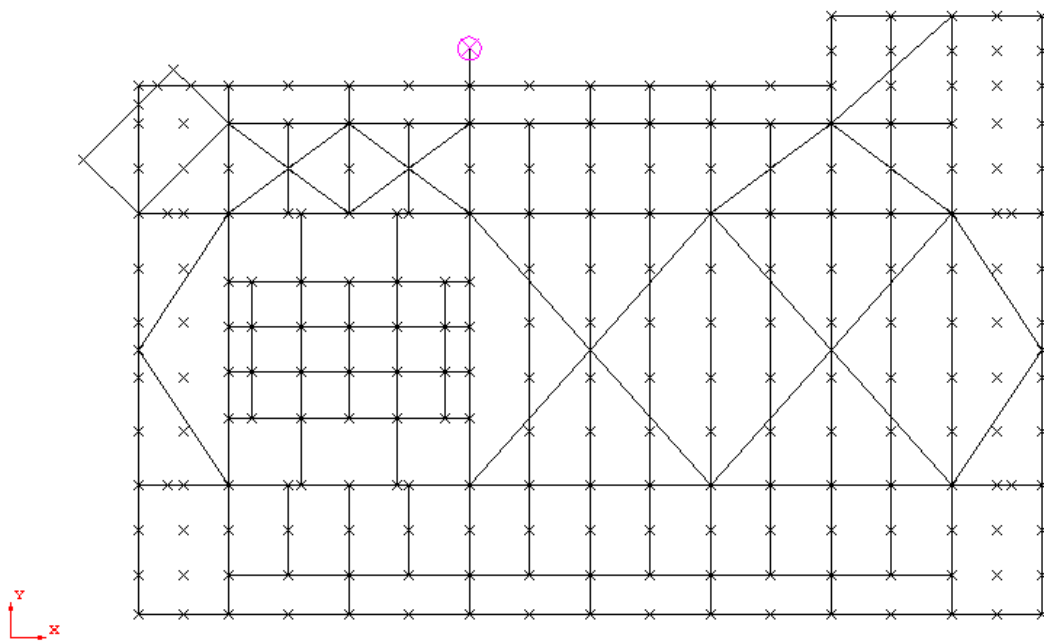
Grúa de pedestal – Aplicación de cargascubierta superior.
